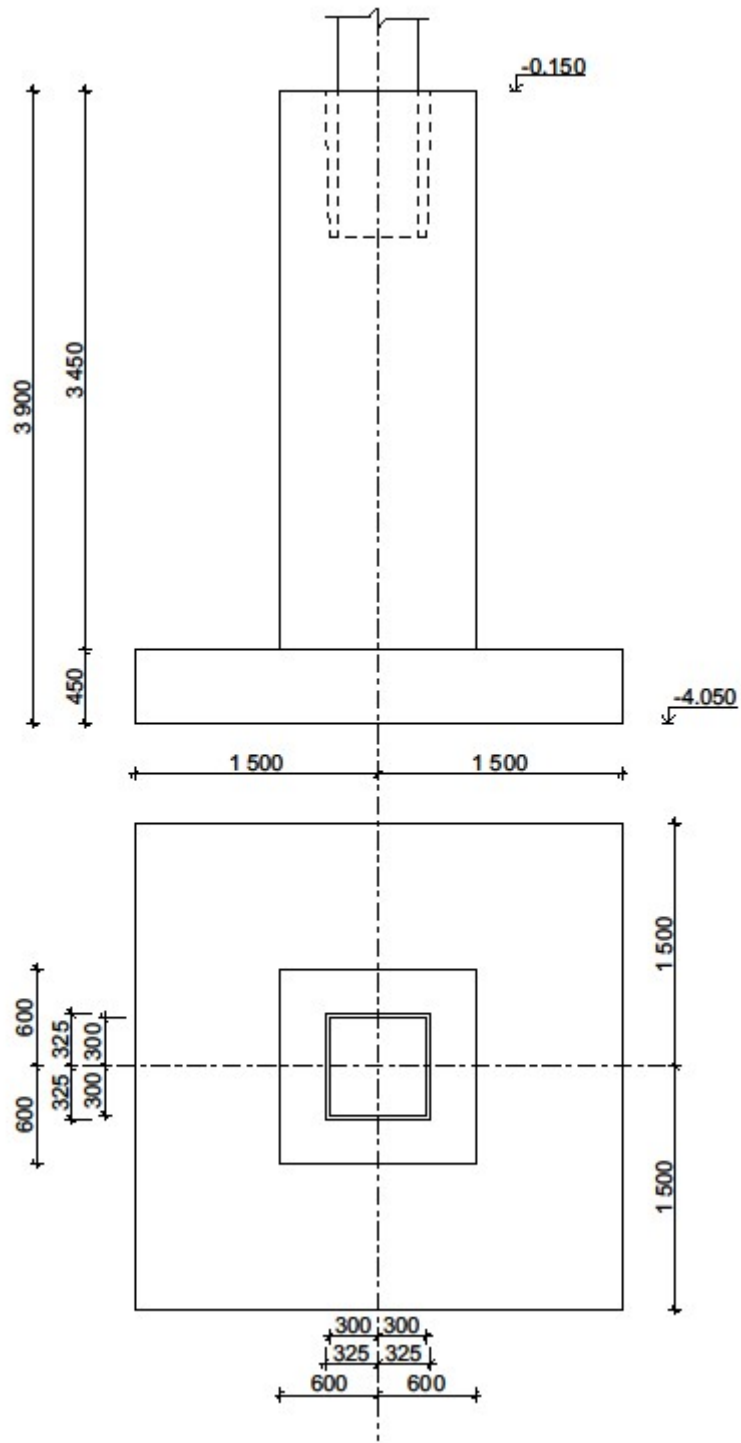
Конструктивне рішення стовпчастого фундаменту мілкого закладання під збірну залізобетонну колону
